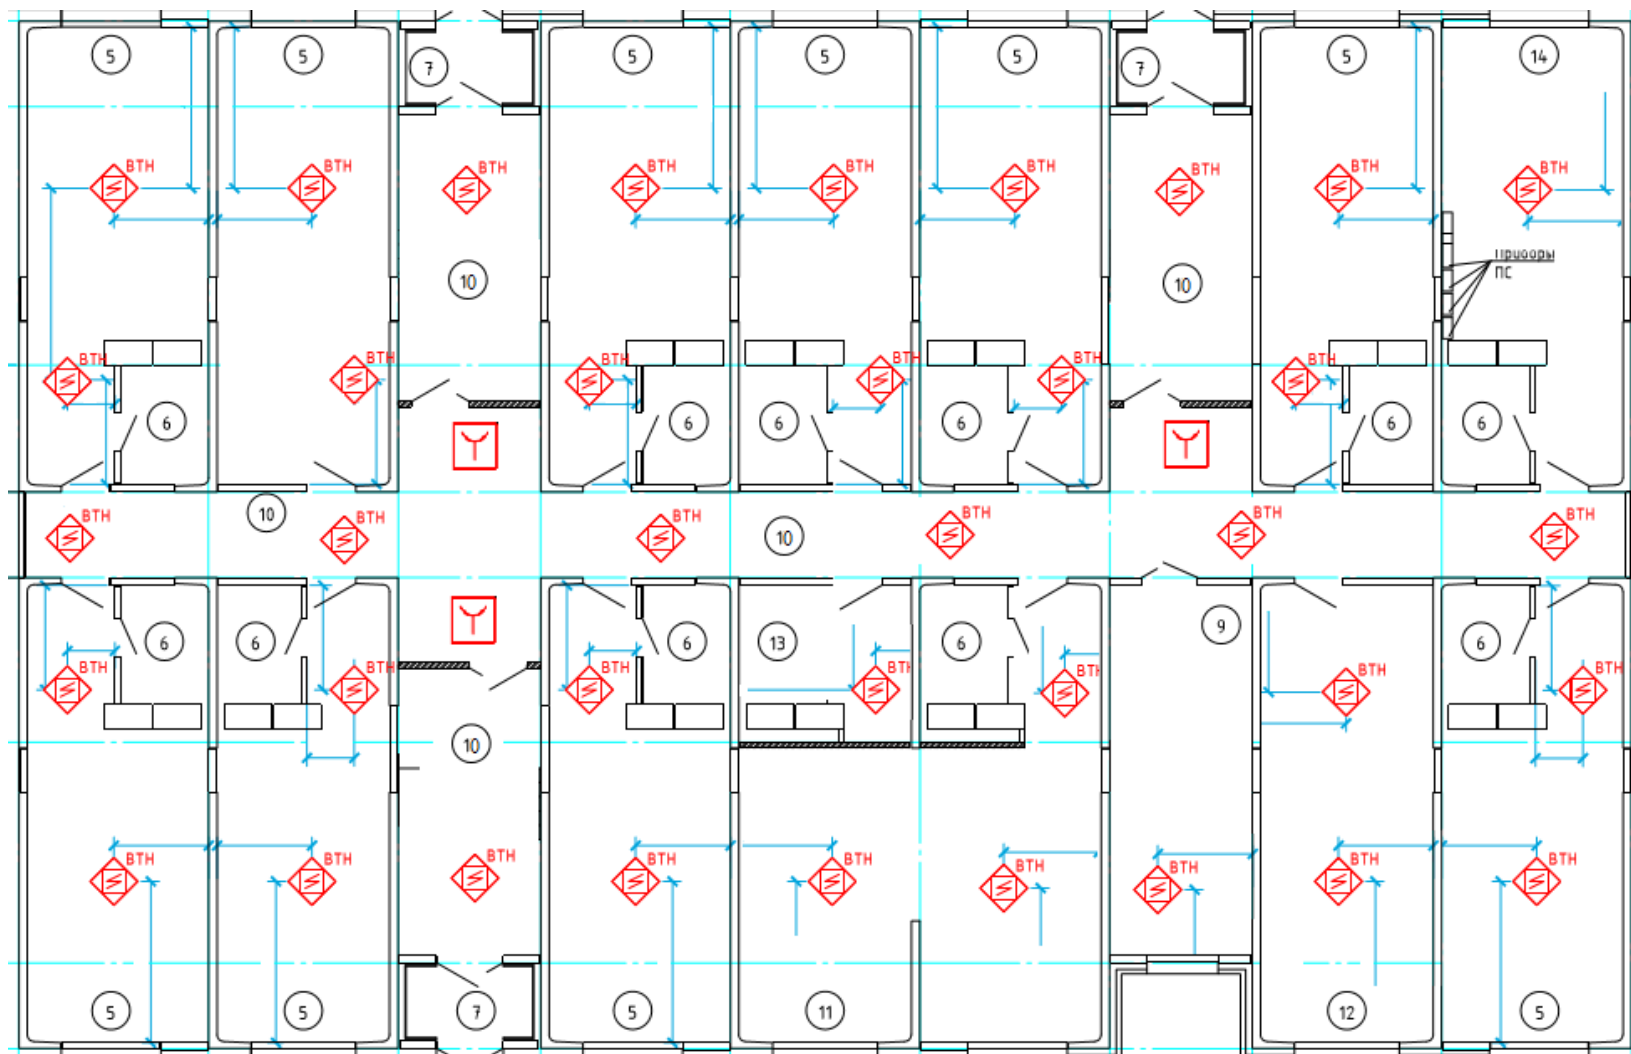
План прокладки ИПР и ДИП здания АБК
